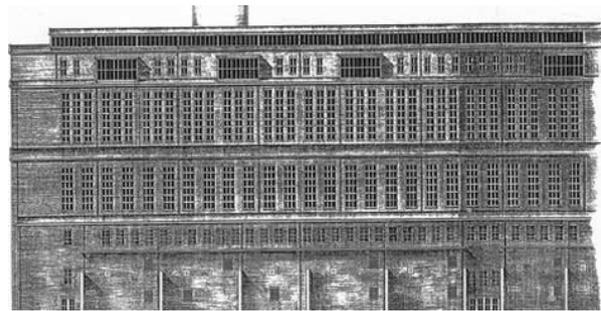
Fassadenausschnitt der Südfassade des Kraftwerks, Entwurf Baake (VEAG-Archiv).
